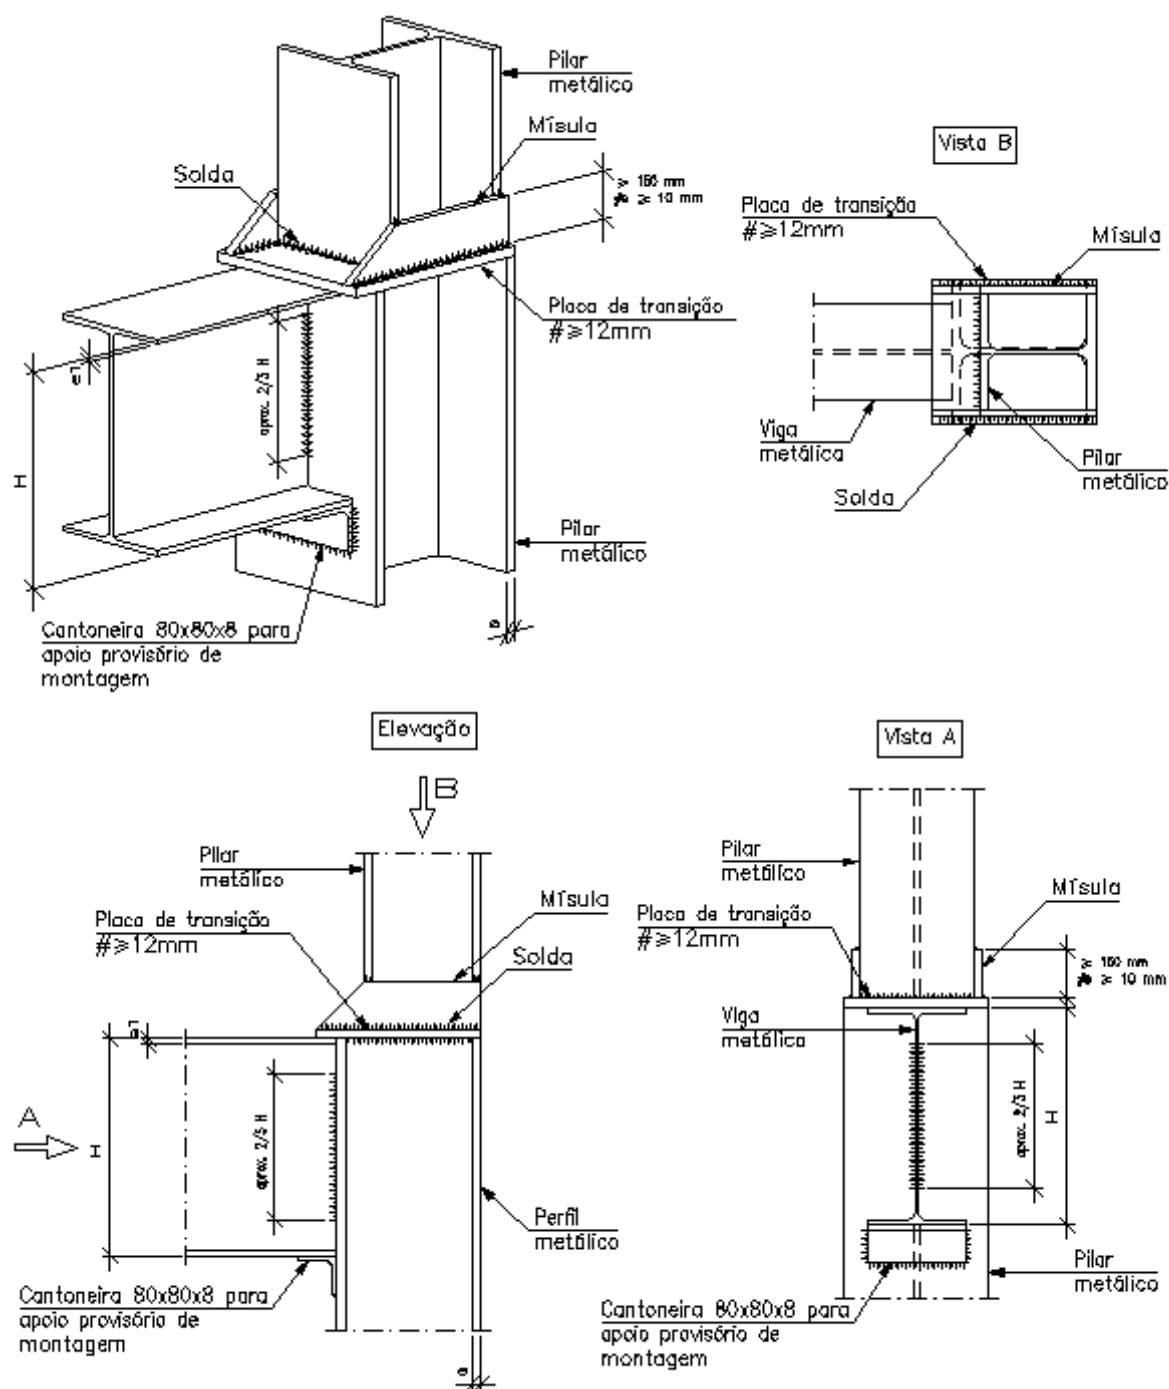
Ligação semi-rígida de vãos adjacentes com pilar da última planta
